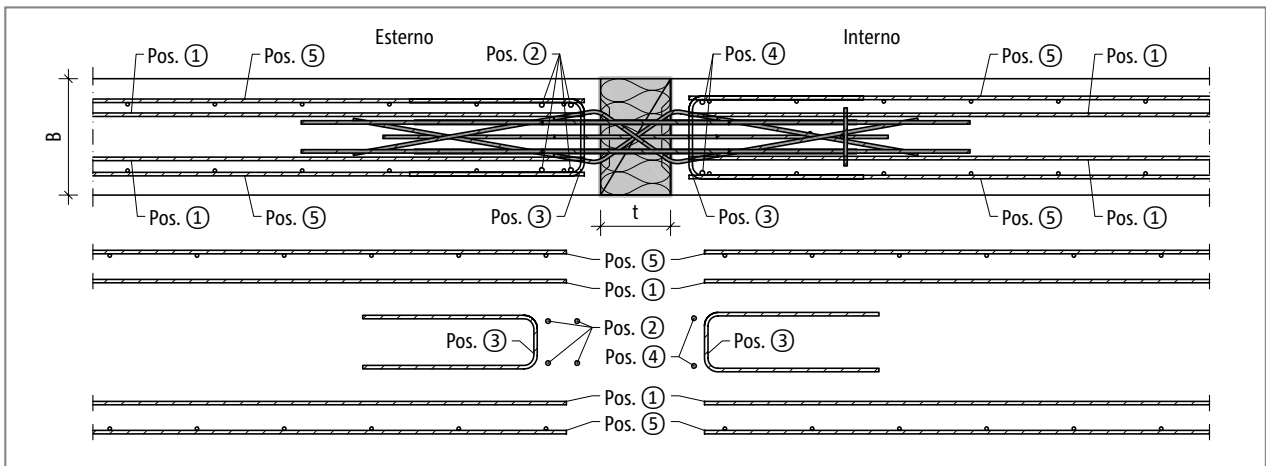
Schöck Isokorb® tipo WXT: armatura in opera; pianta
